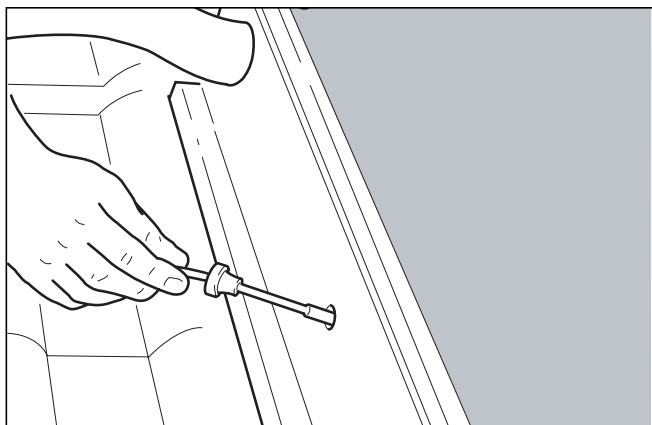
Tylko przy pionowym montażu kolektorów: wstawić najpierw kolektory w uchwyty dachowe.
